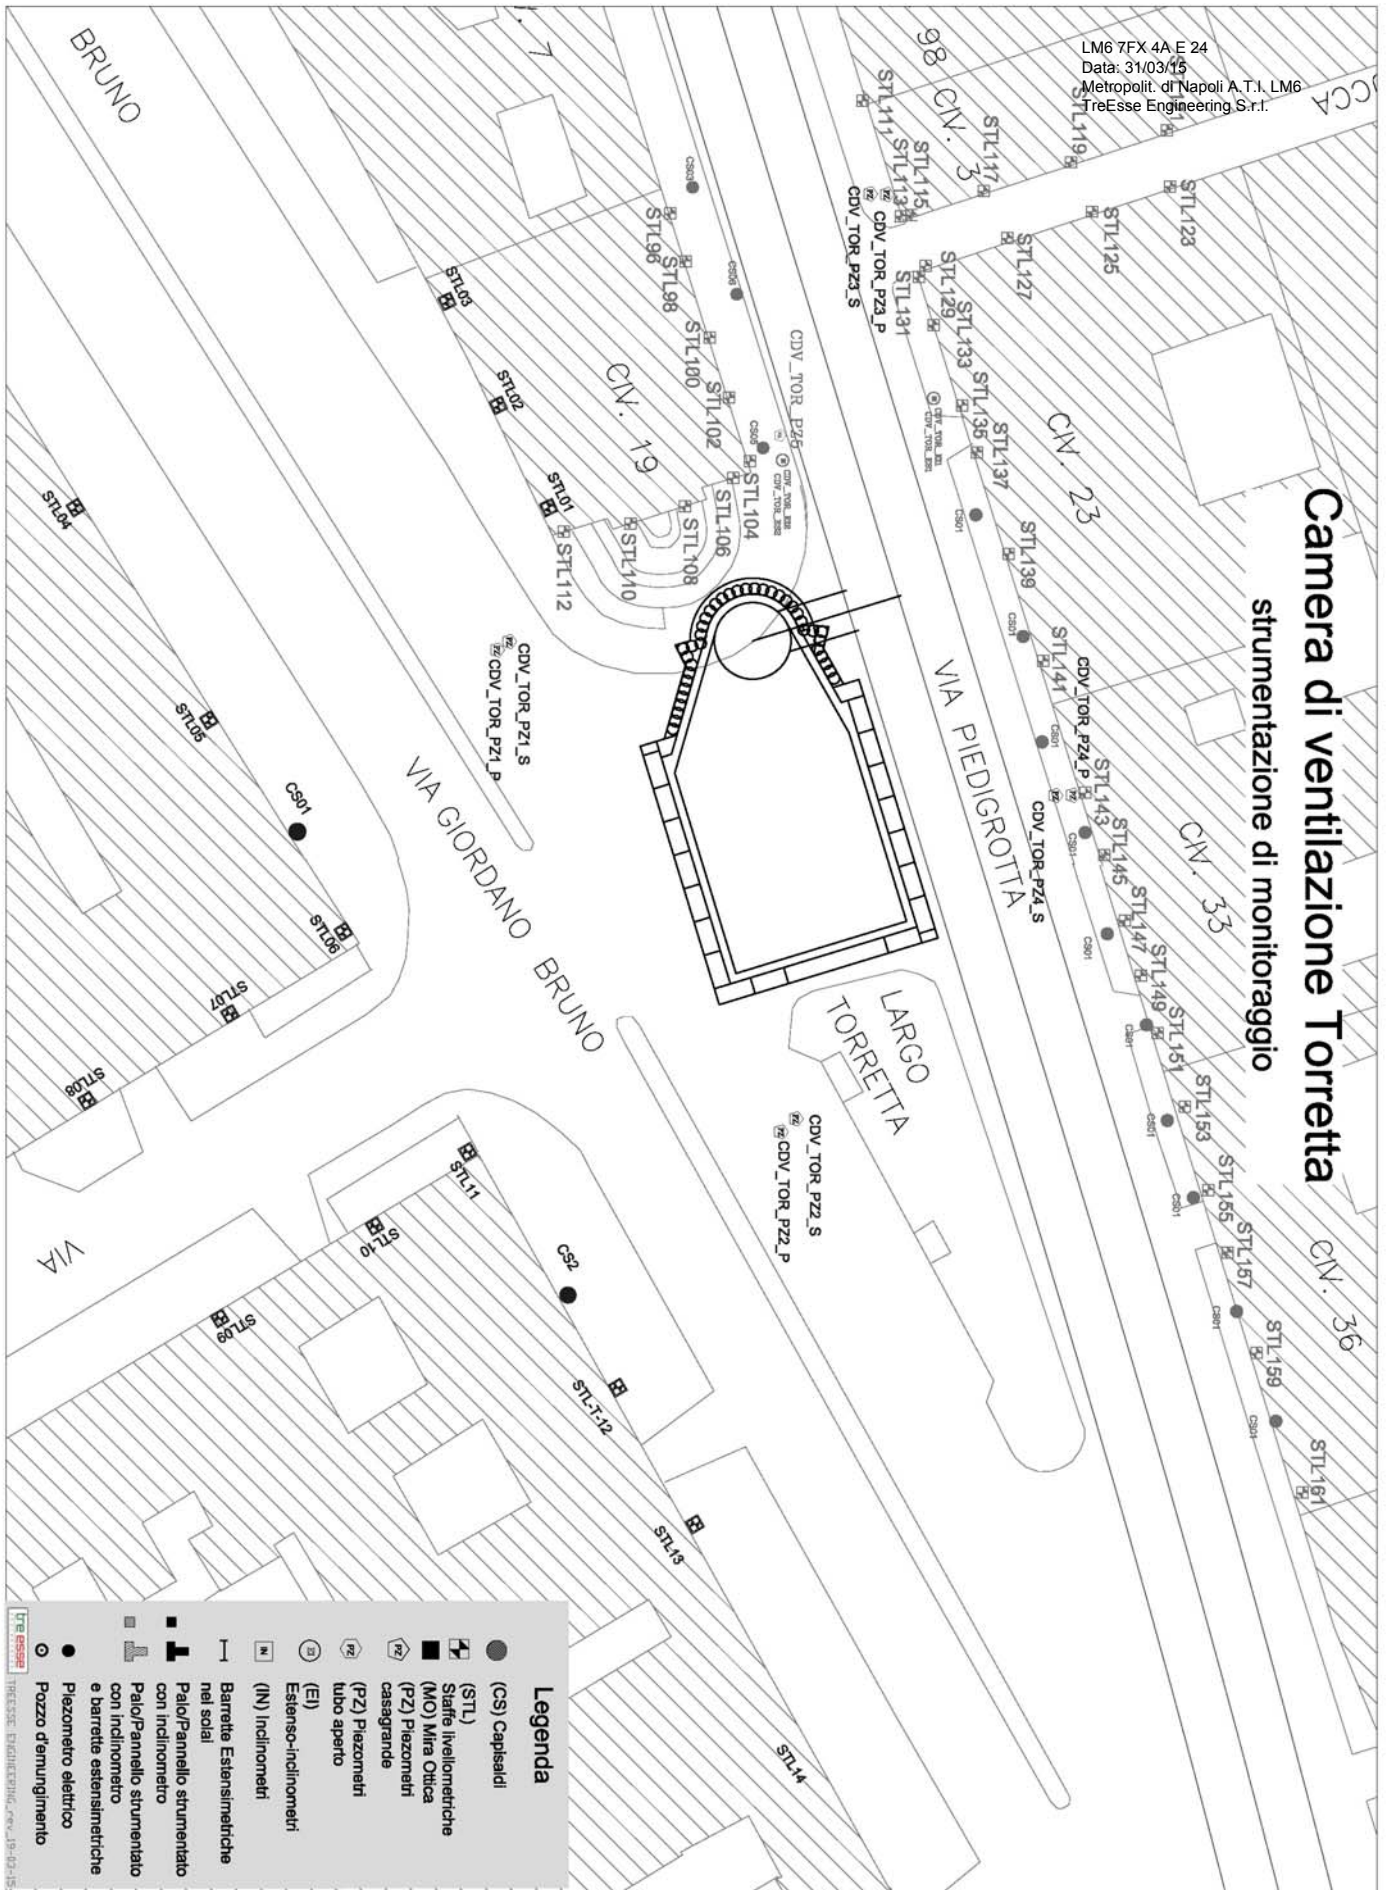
Planimetria Camera di Ventilazione “TORRETTA”, raffigurante la disposizione della strumentazione di monitoraggio.
